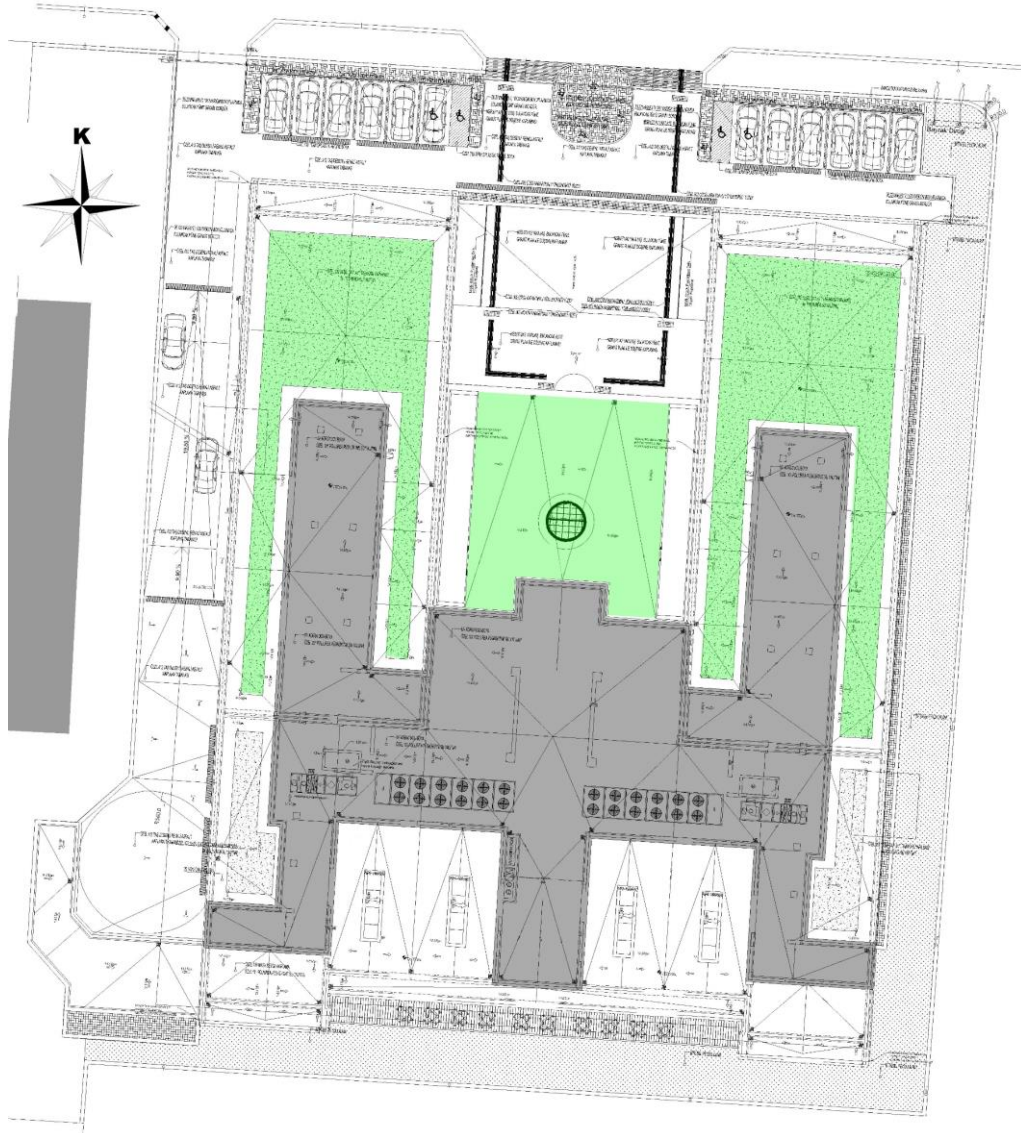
Ordu Ek Adliye Hizmet Binası Vaziyet Planı (Fotoğraf: Yandex Haritalar Erişim: 02.05.2019)
